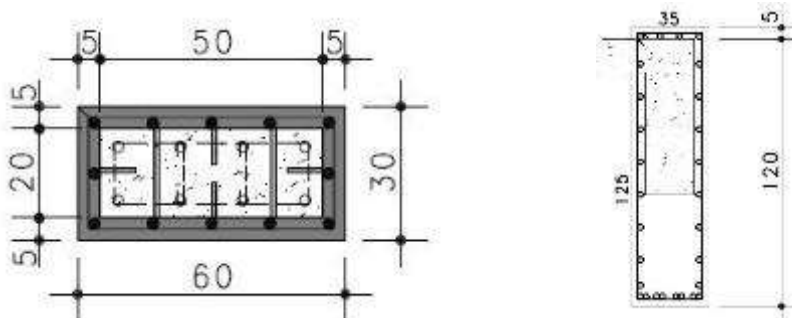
Reforço típico dos pilares e vigas via encamisamento.
